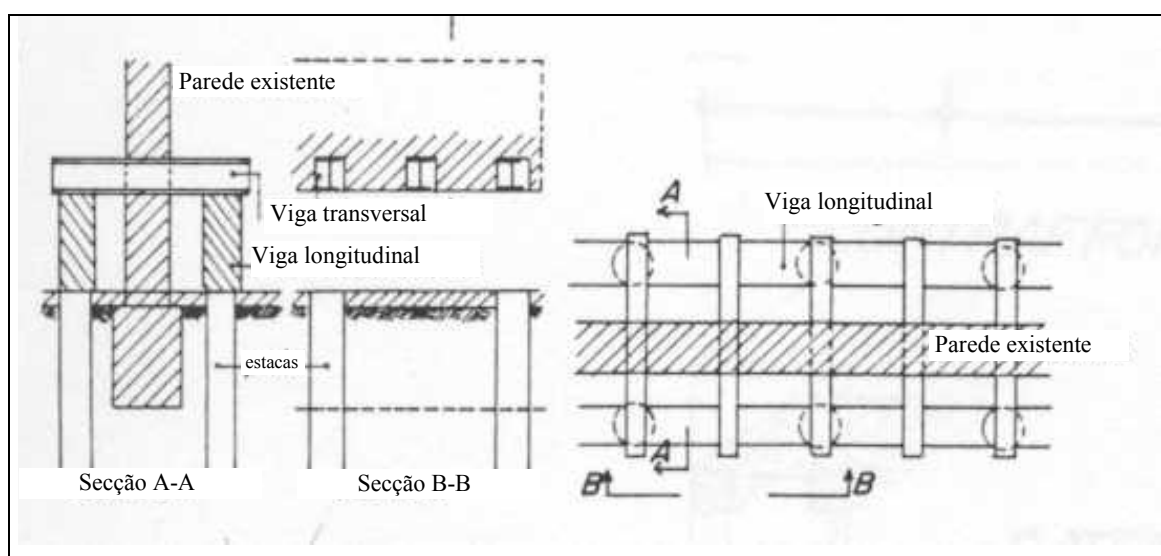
Transferência de cargas, através de vigas transversais, para estacas adjacentes, paralelas à fundação existente [Piccirilli, 1996].
